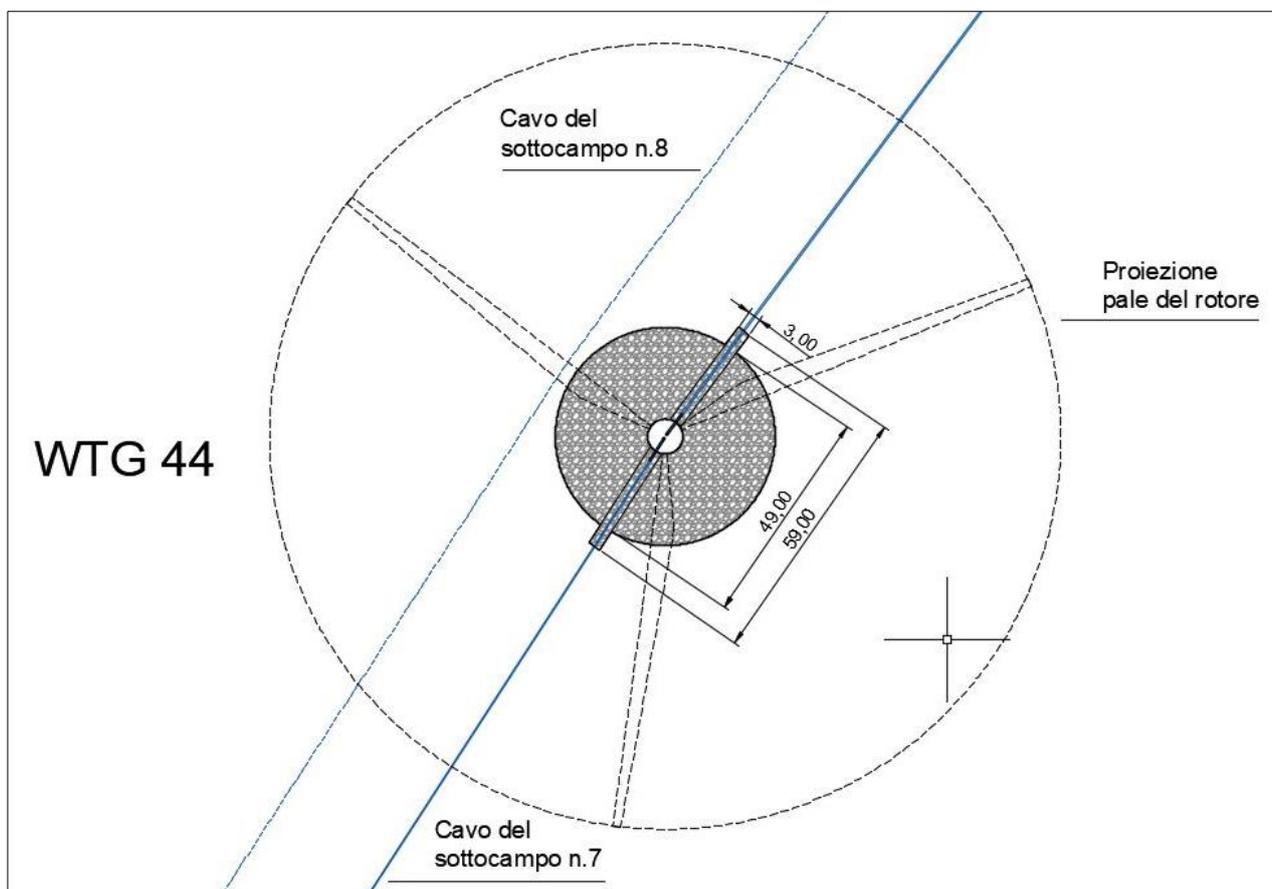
Estensione della protezione anti scoring e “baffi” di ingresso e uscita del cavo, protetti da pietrame.
